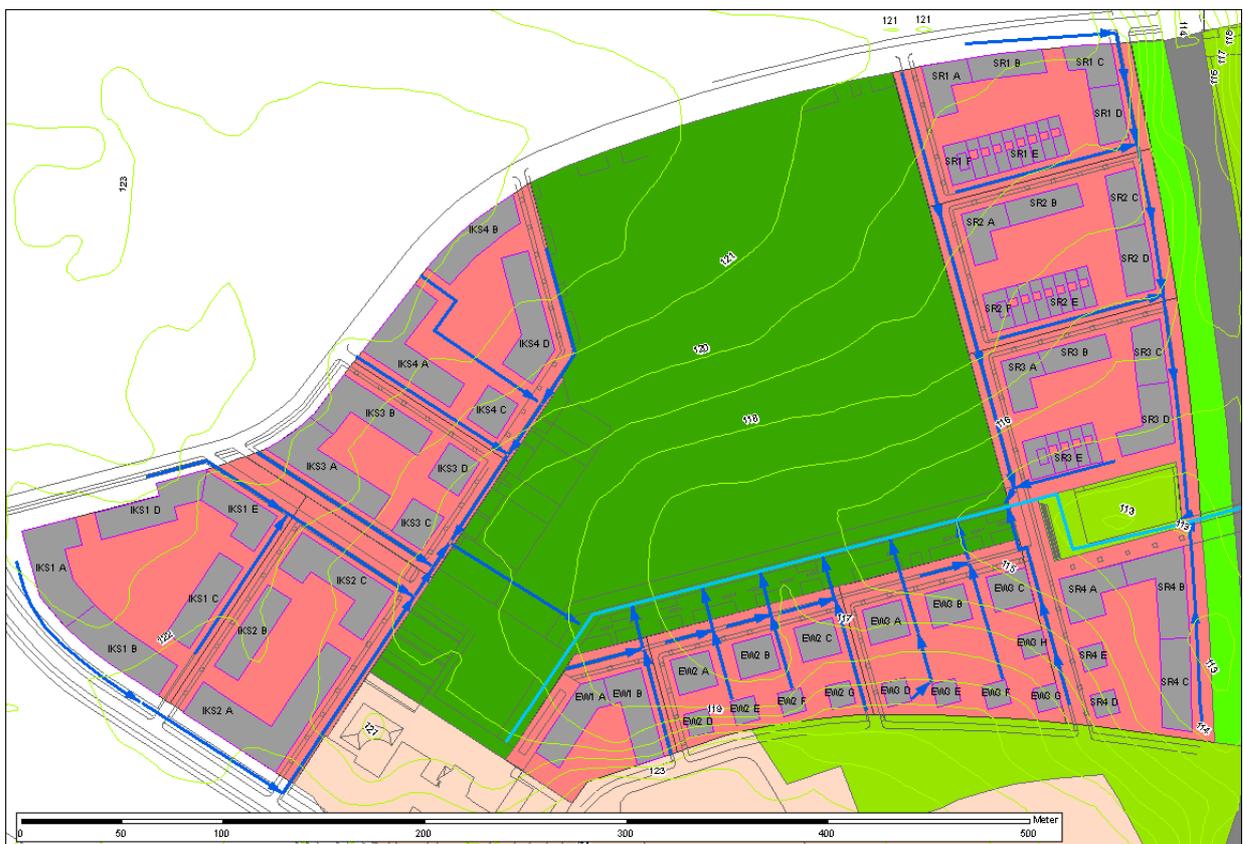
Lage und Richtung der Regenwasserrinnen
